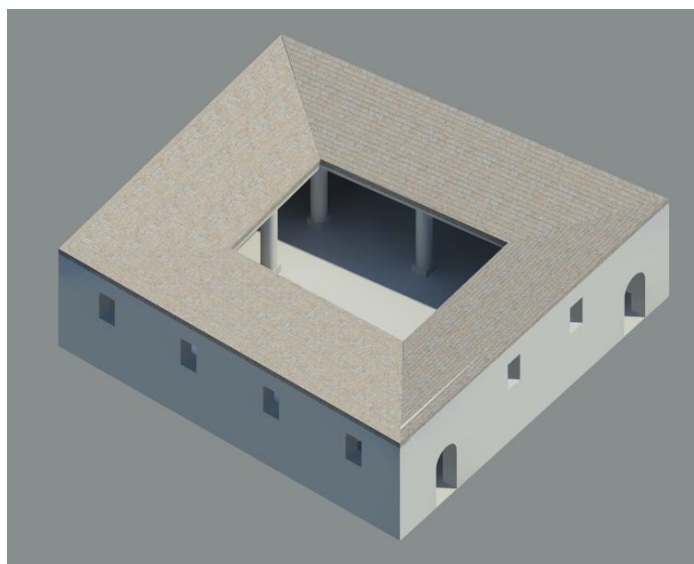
Peristilio a otto colonne. Ricostruzione 3D vista da nord-est (elaborazione grafica dell'autore).
